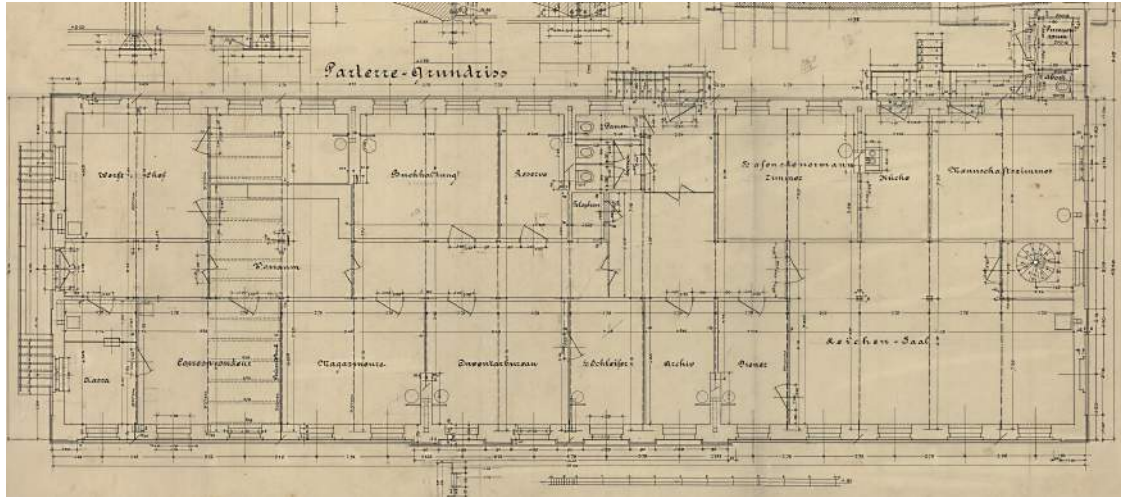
Ausschnitt aus dem Originalplan von 1911; Parterregrundriss
